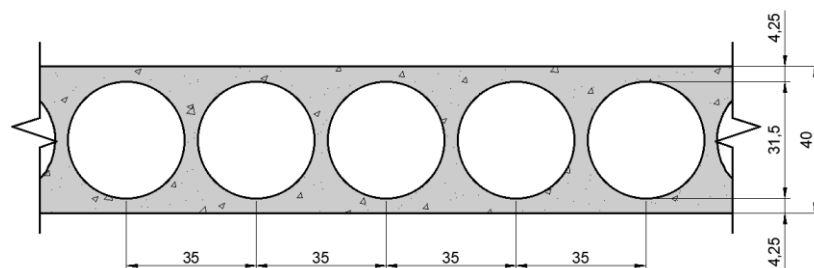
Projeto C3 - Seção transversal da laje *BubbleDeck* (dimensões em cm).
